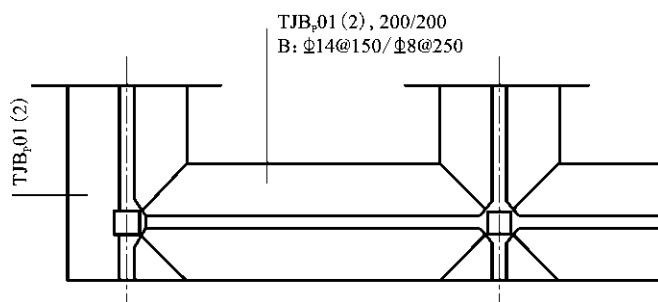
板式条形基础配筋横断面图 [平法图集(22G101—3)第 2-21 页]
